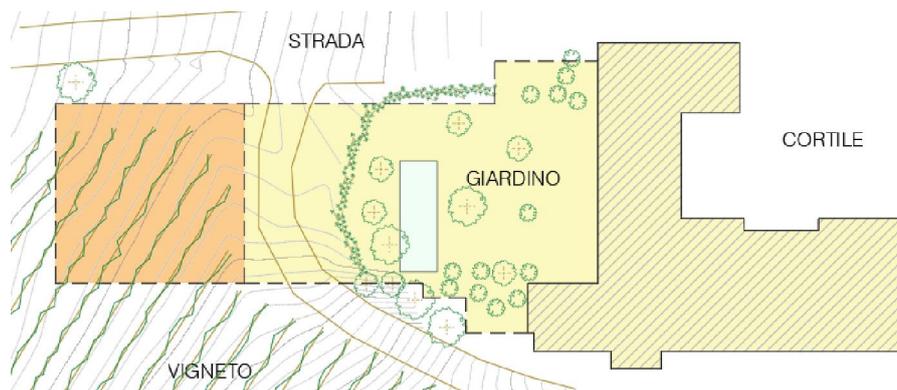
Planimetria generale cantina "Cascina Nuova"
